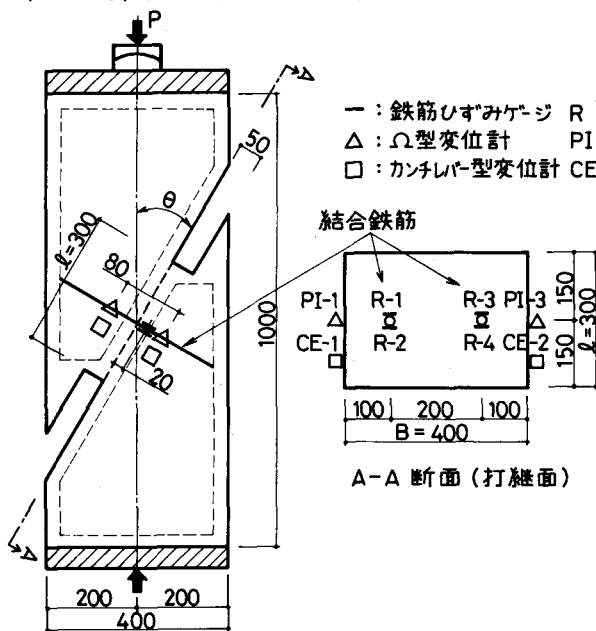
試験体寸法および鉄筋ひずみゲージ変位計測定位置
